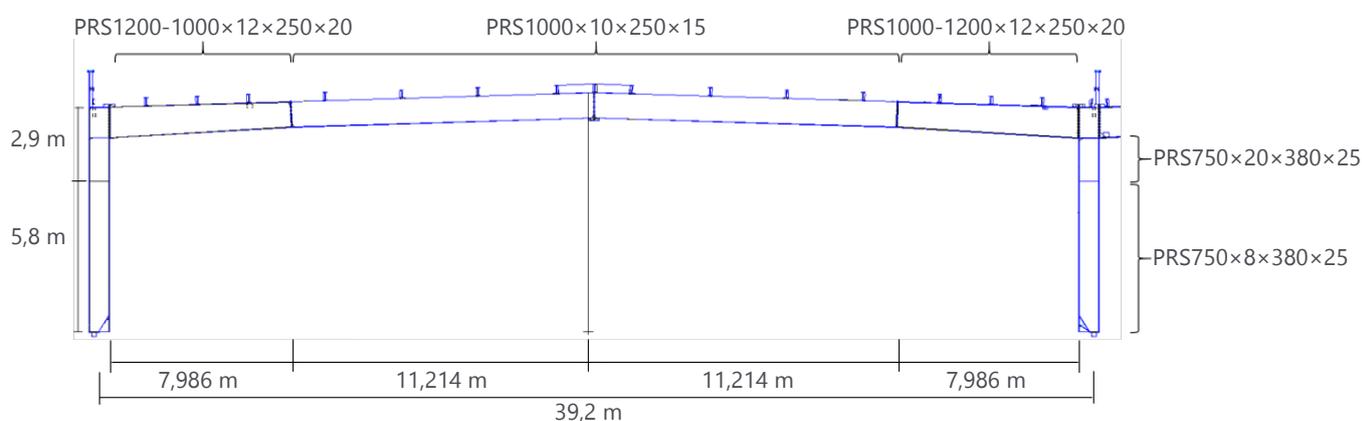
Dimensions d'une travée du portique étudié (sections des PRS en mm)
